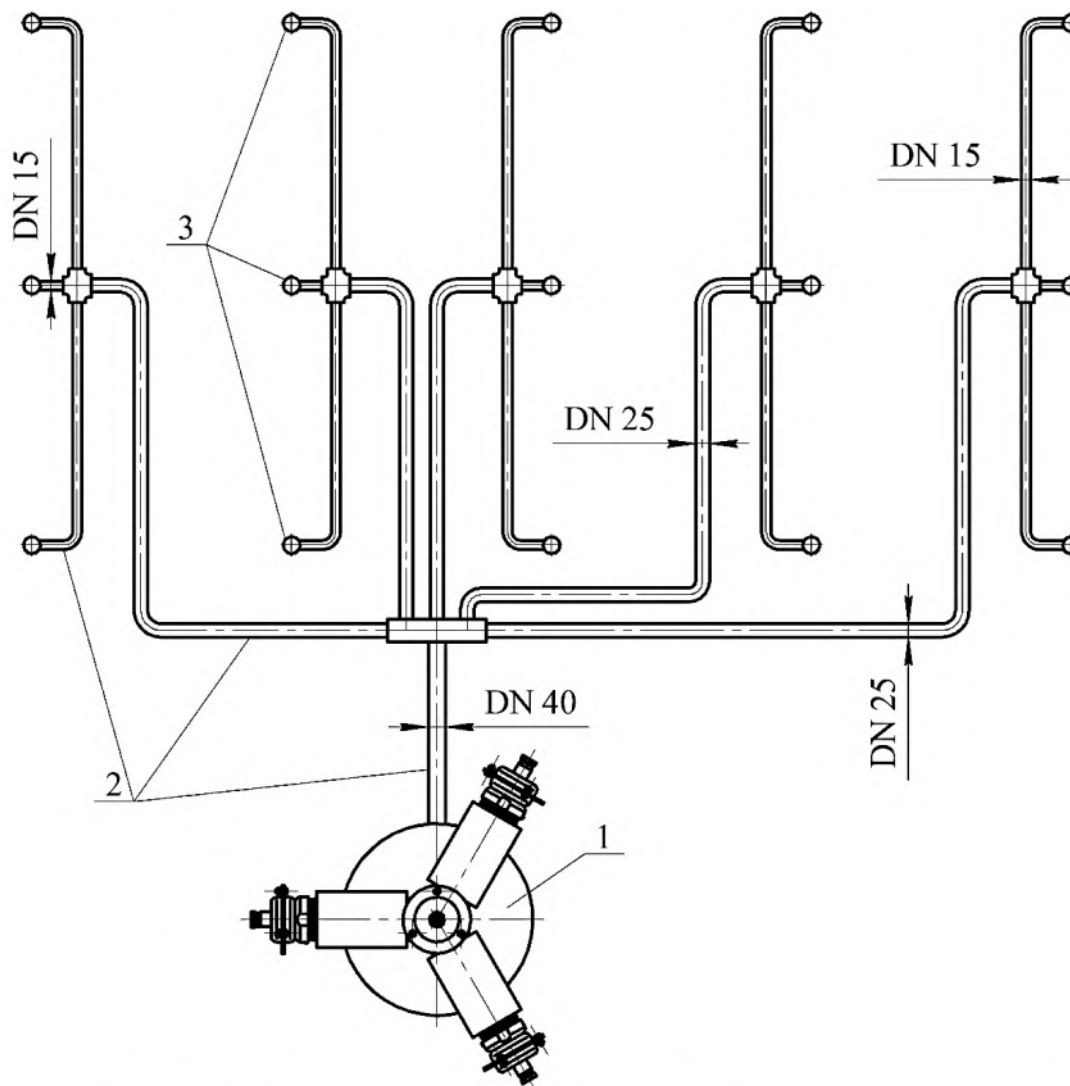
Вариант трубной разводки для 15-ти насадков-распылителей
